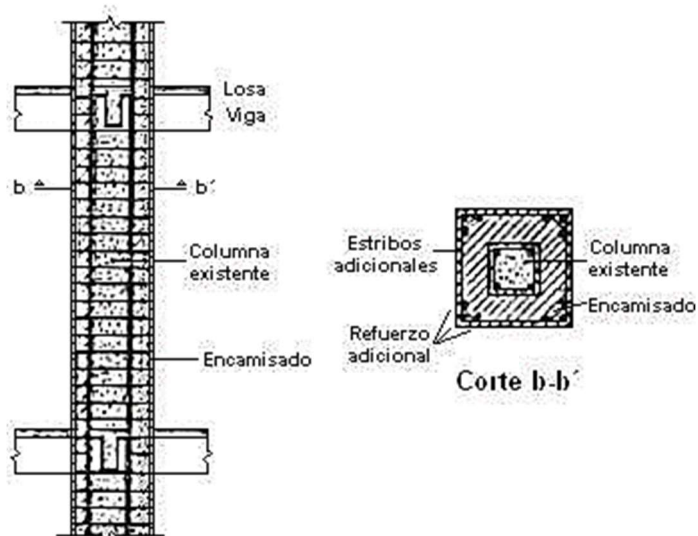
Encamisado de una columna hasta la losa (UNDP/UNIDO, 1983)
